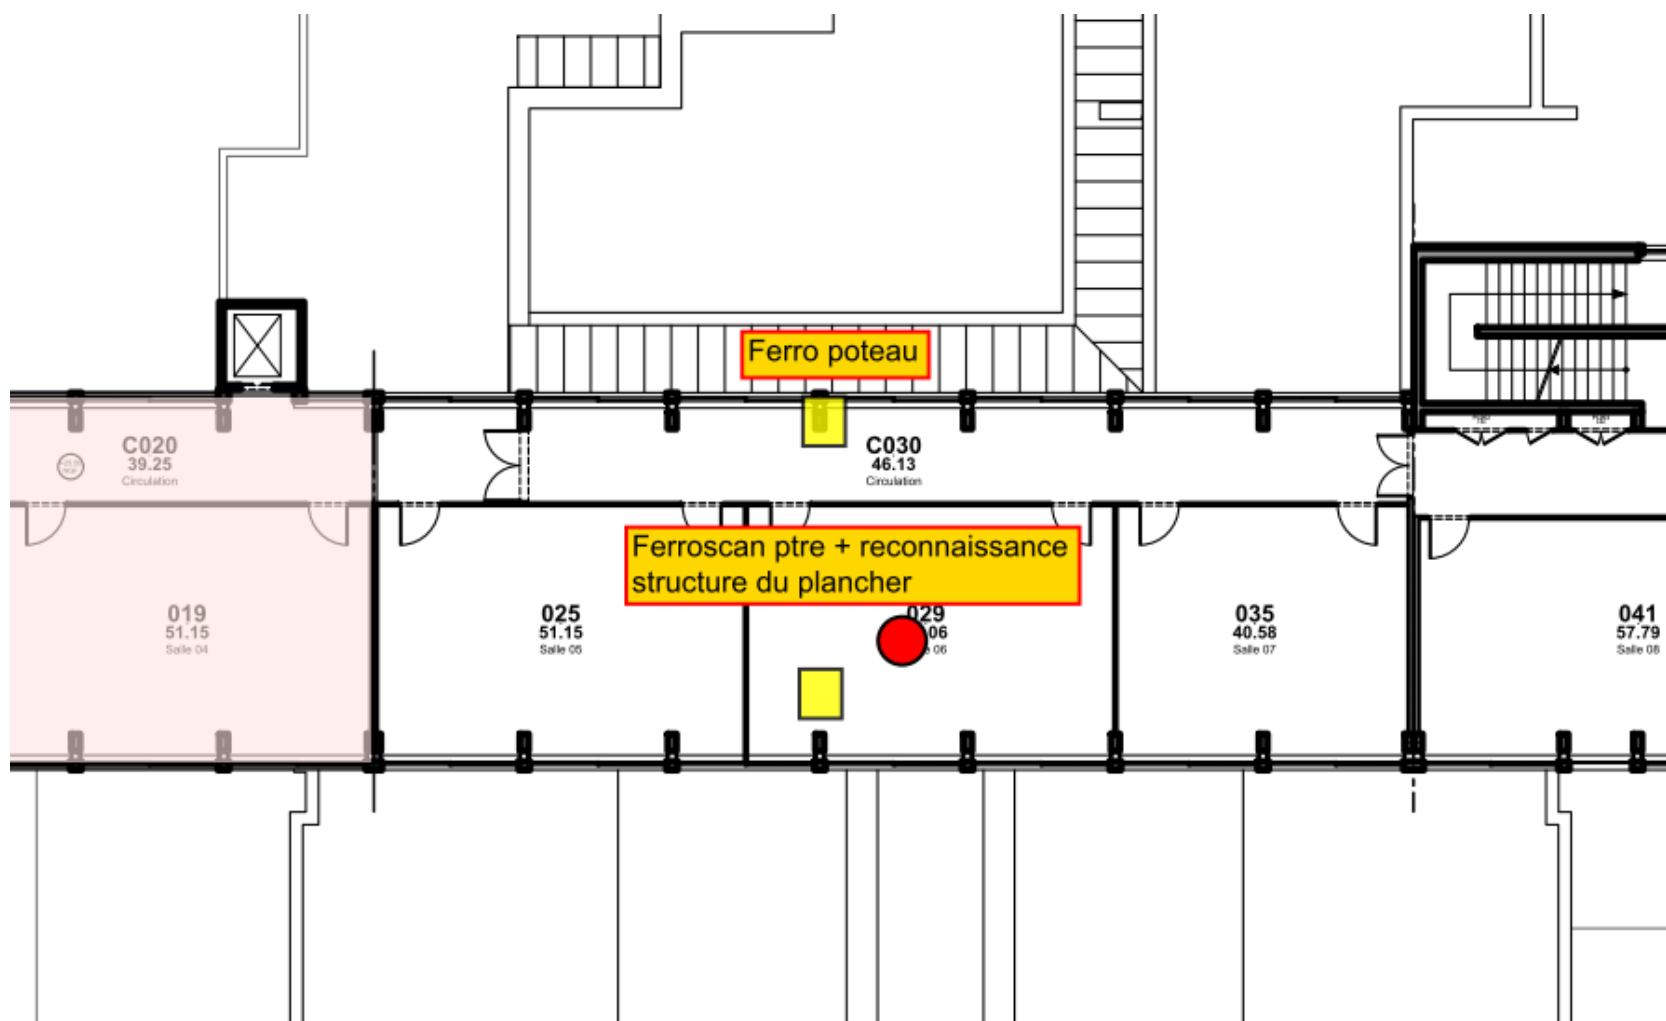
BATIMENT 1 – Plancher haut niveau 0
